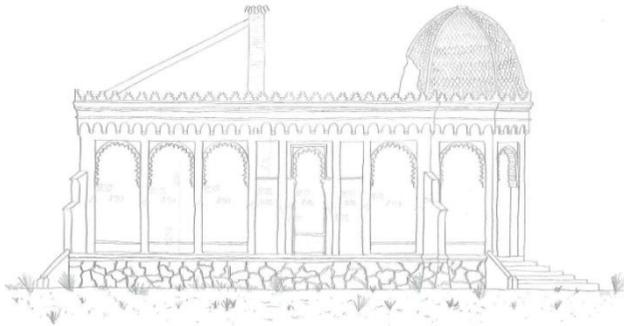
Croquis Alzado Norte (2014) - Fuente propia
